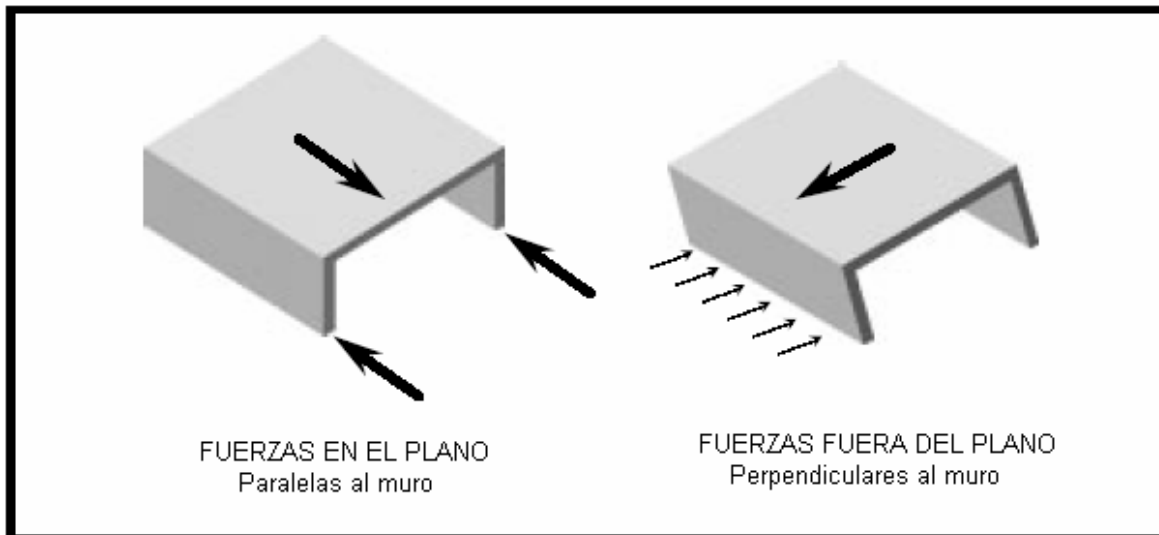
Fuerzas en el plano y fuera del plano a través del muro (ATC)
